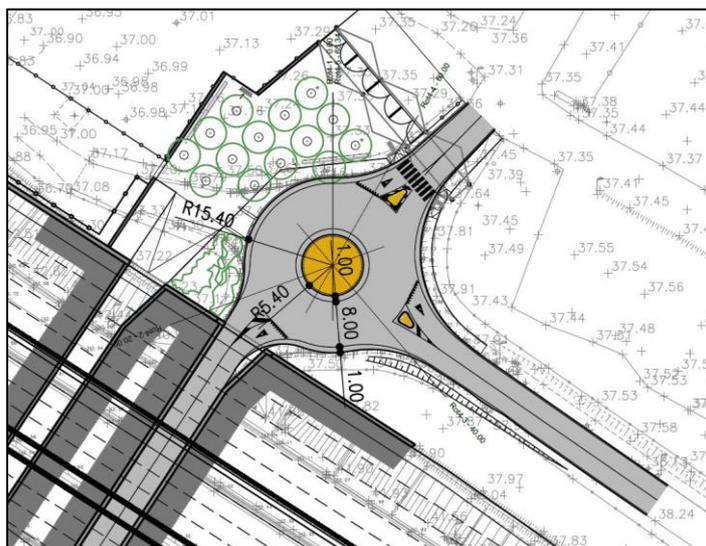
Stralcio planimetrico rotonda via Zambecari
